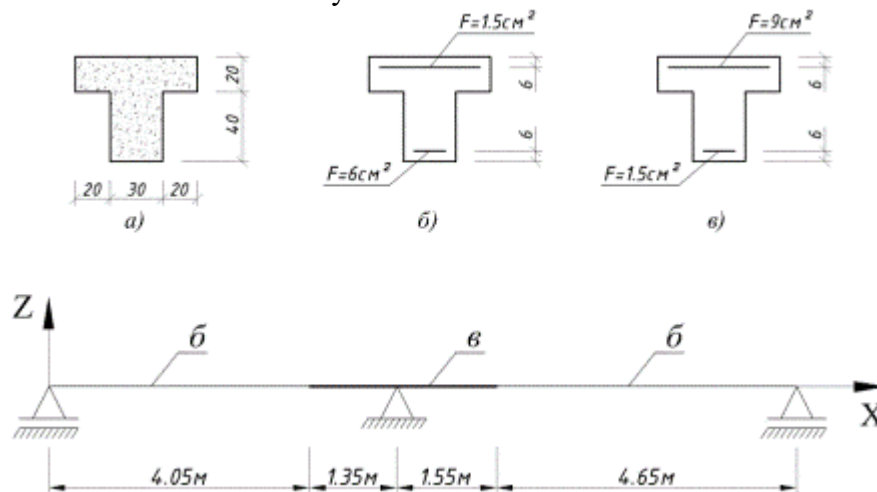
Сечения элементов балки: а) размеры сечения; б) пролетное сечение; в) опорное сечение
